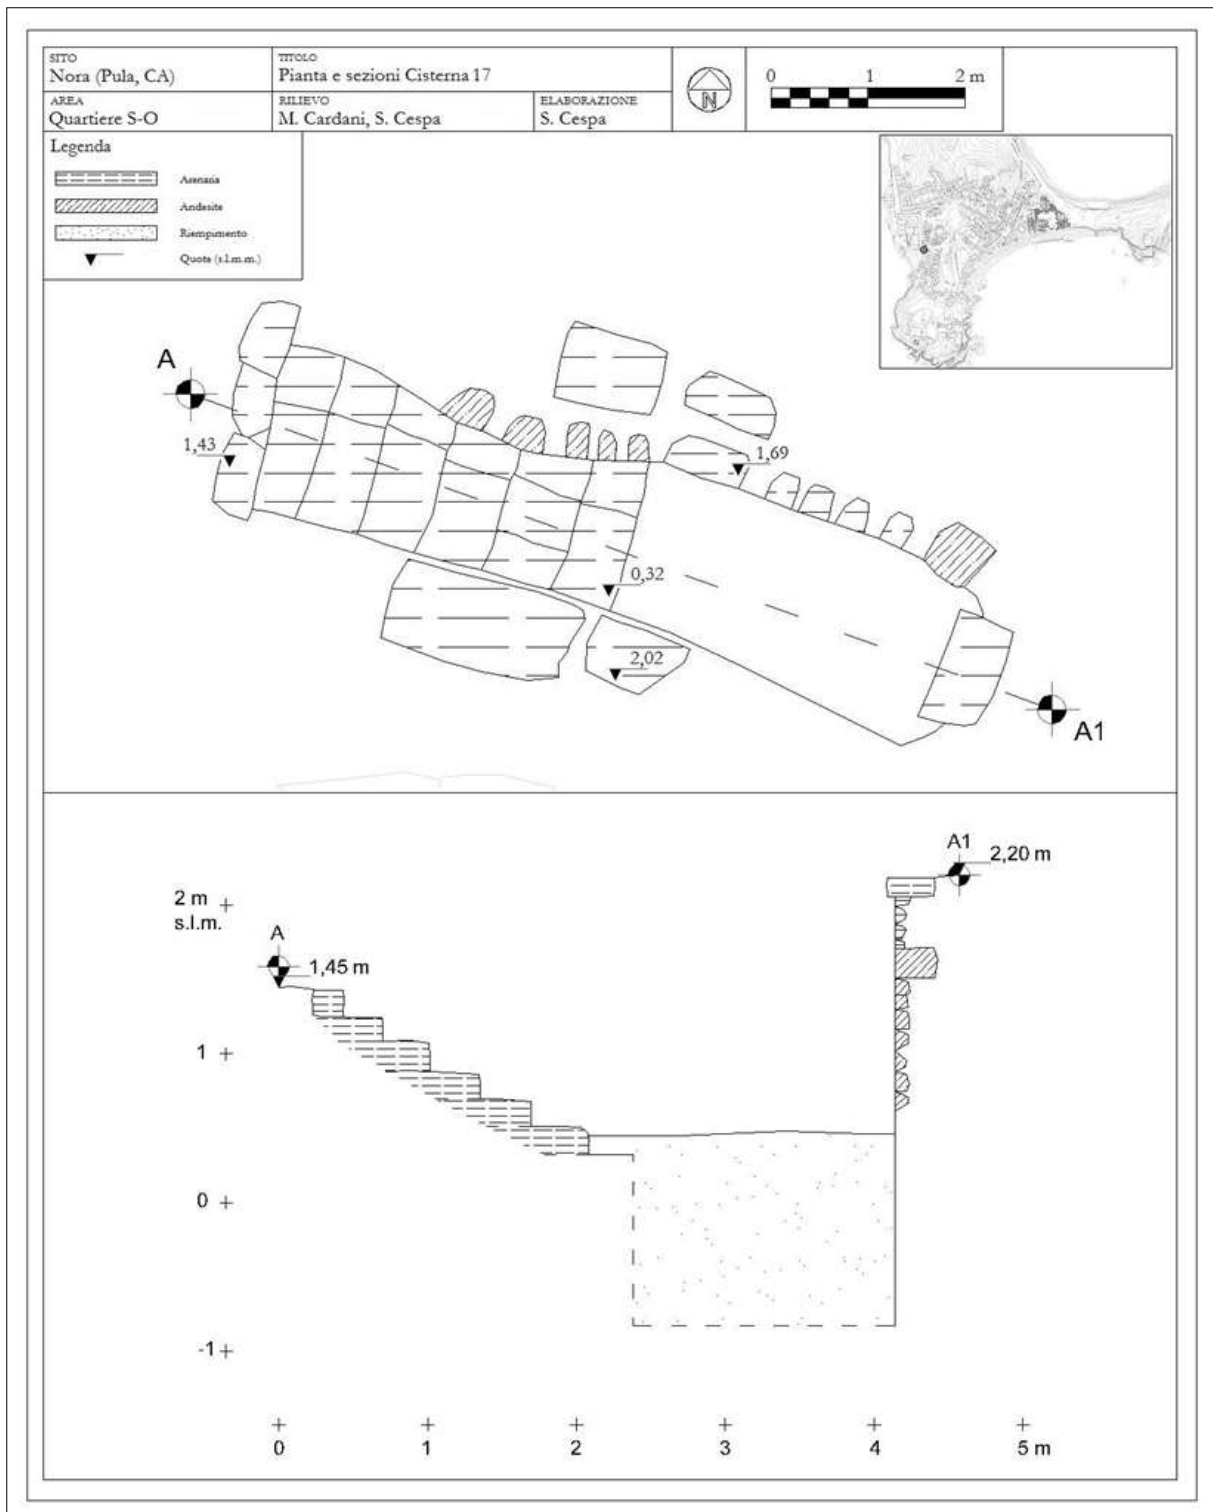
Pianta e sezione della cisterna 17 (elaborazione dell'autore).
